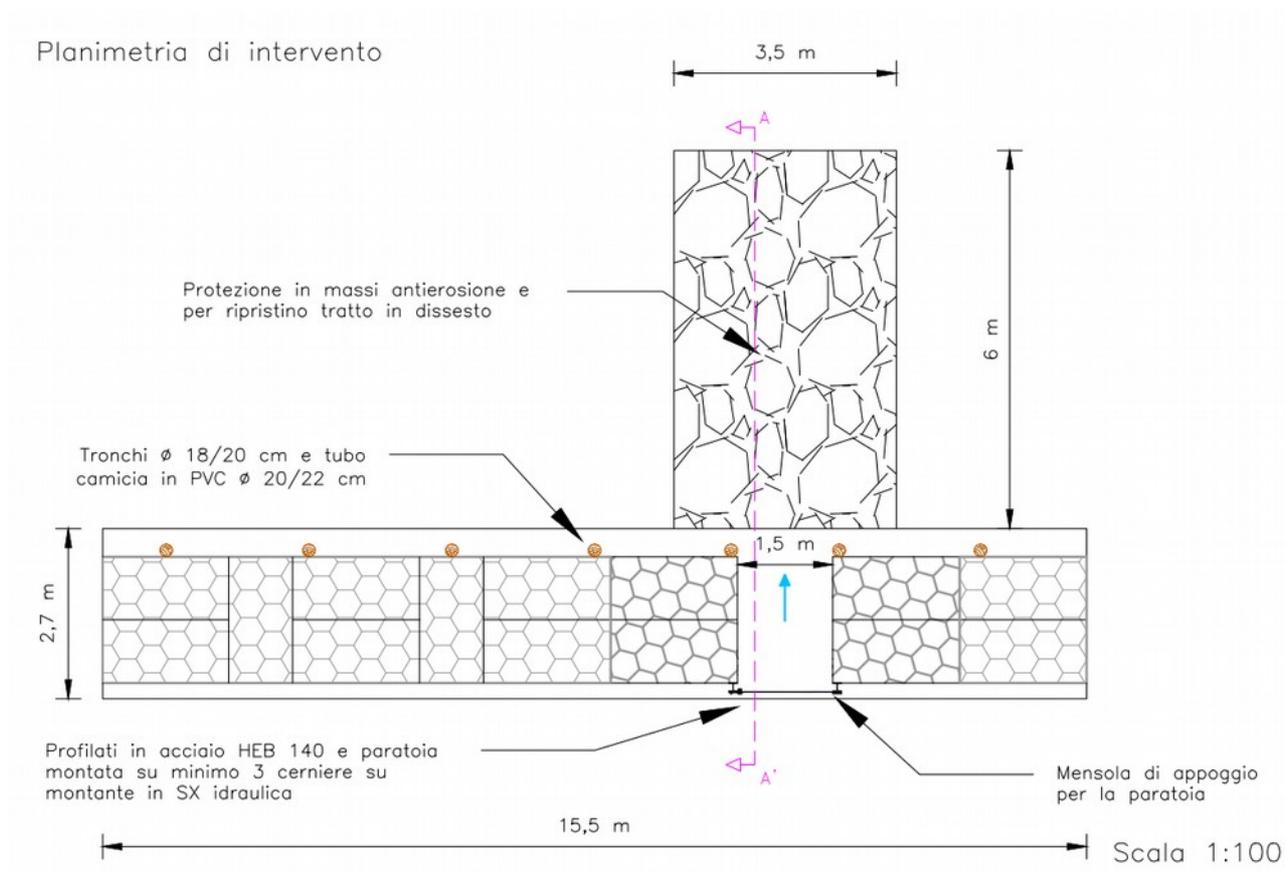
Schema planimetrico del restringimento di sezione a bocca tarata con anima in pietrame.
